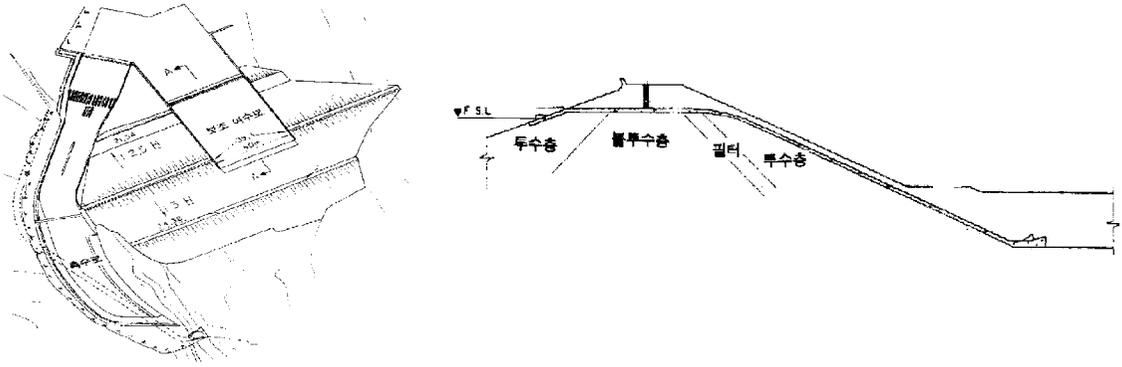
Loerie Dam의 평면도 및 보조여수로 종단면도
